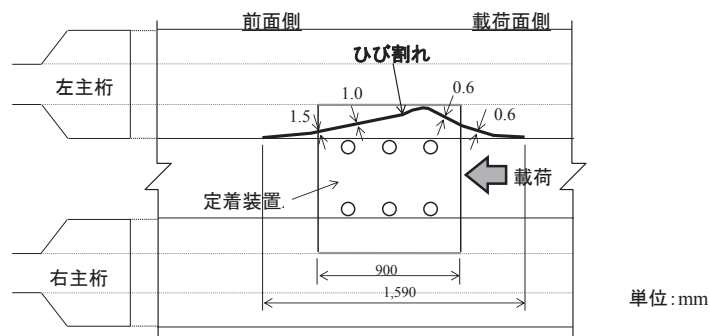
主桁ひび割れ平面図（実験ステップⅡ(25%)終了後）
